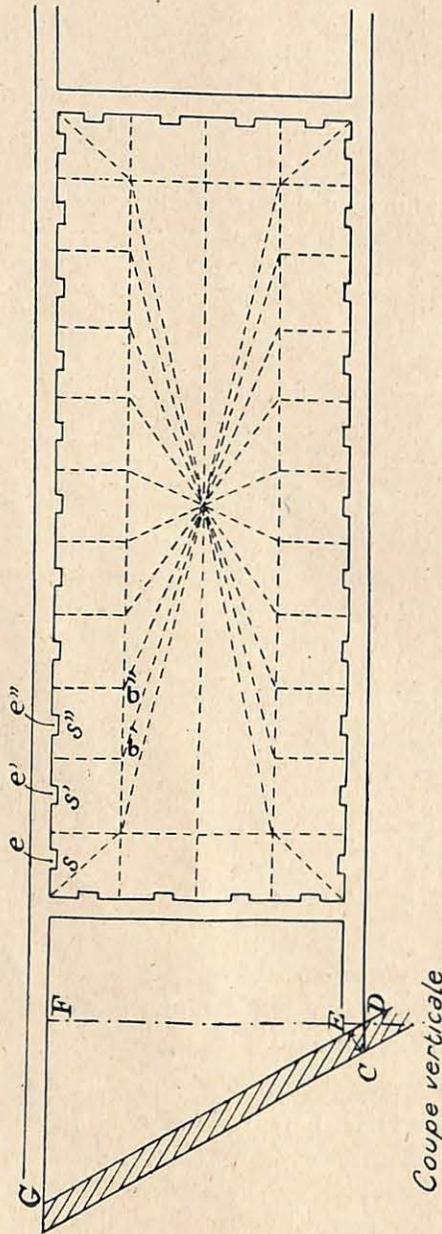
Plan du massif n° 1 dans le plan de la couche ou du filon
